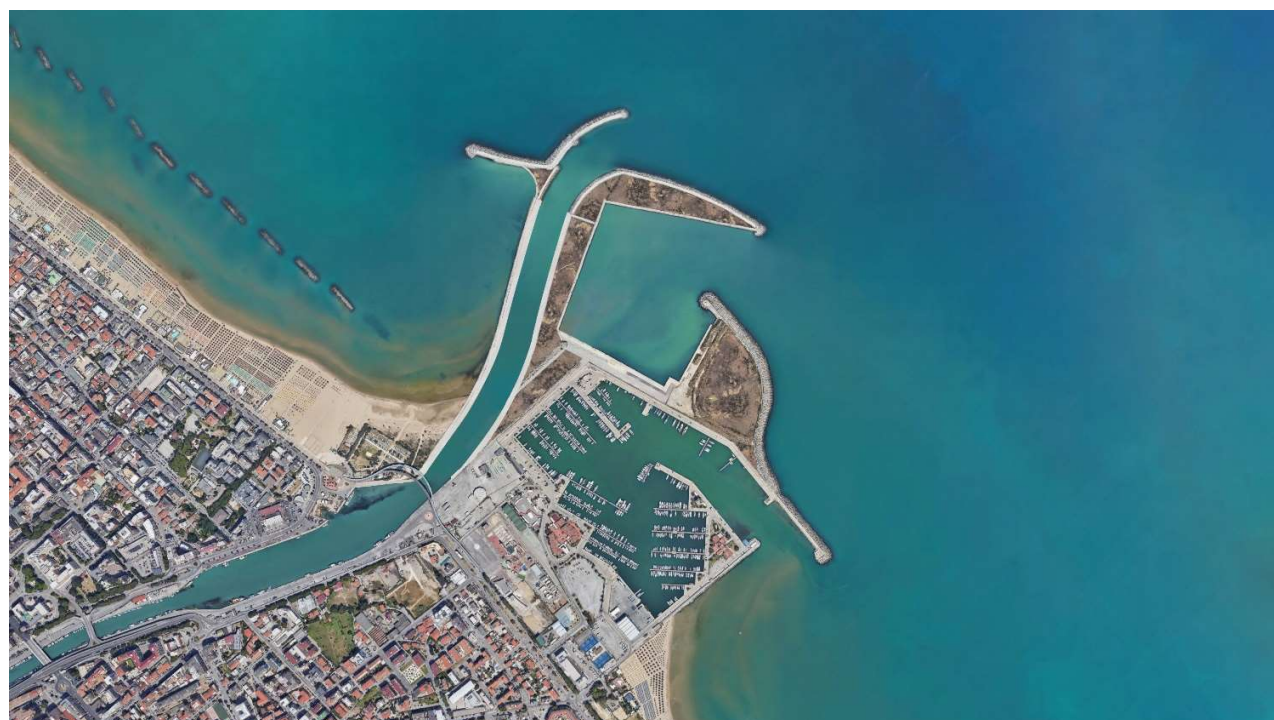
Vista in pianta dell’area di intervento nella configurazione futura
